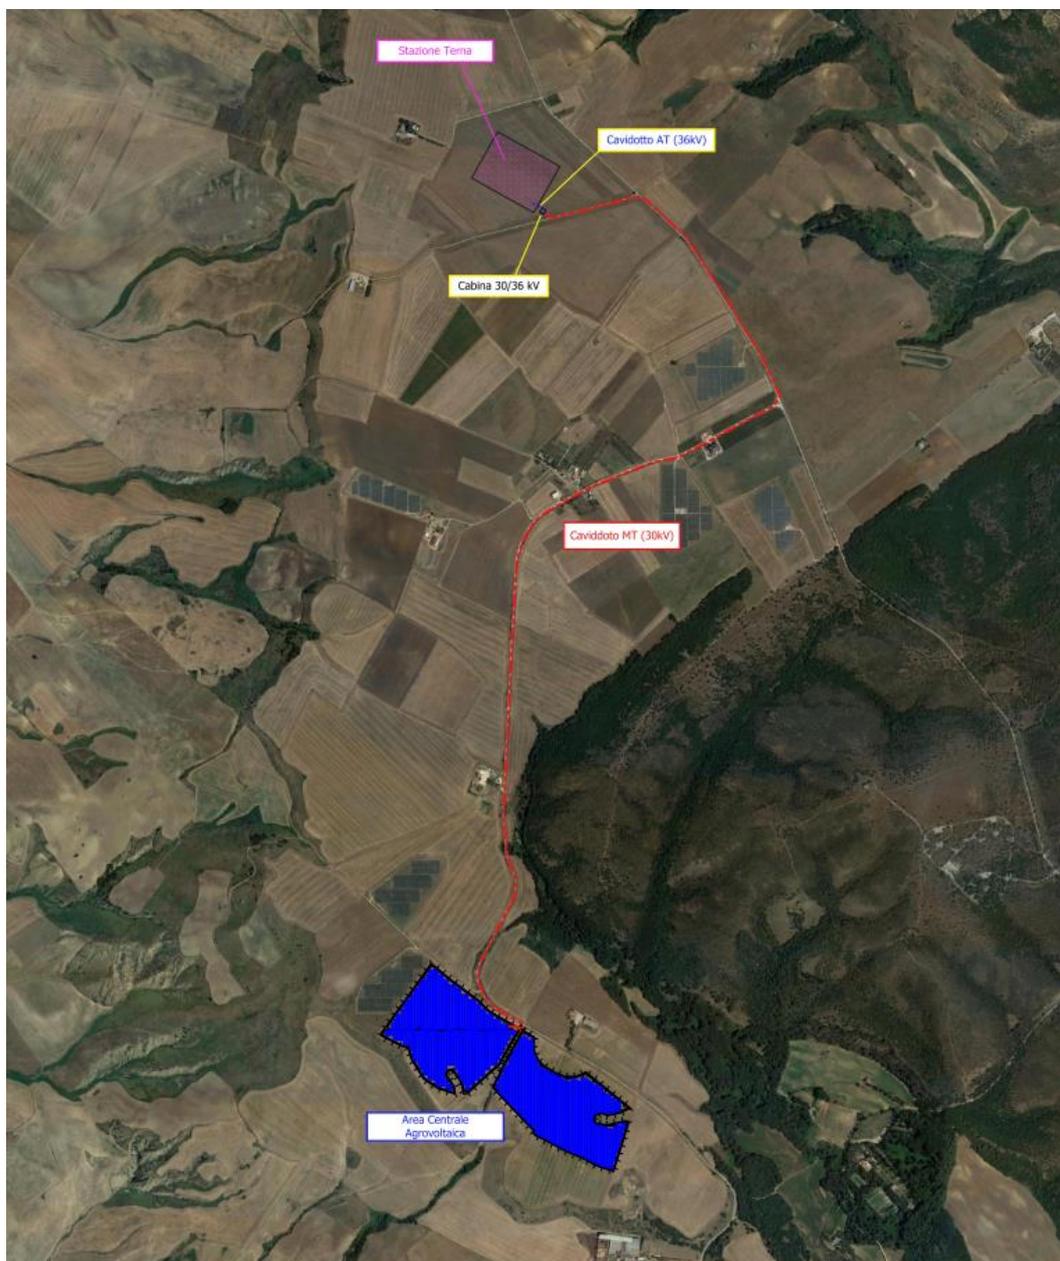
Individuazione impianto in progetto, cavidotto esterno MT e futura stazione Terna S.p.A. su Ortofoto.
